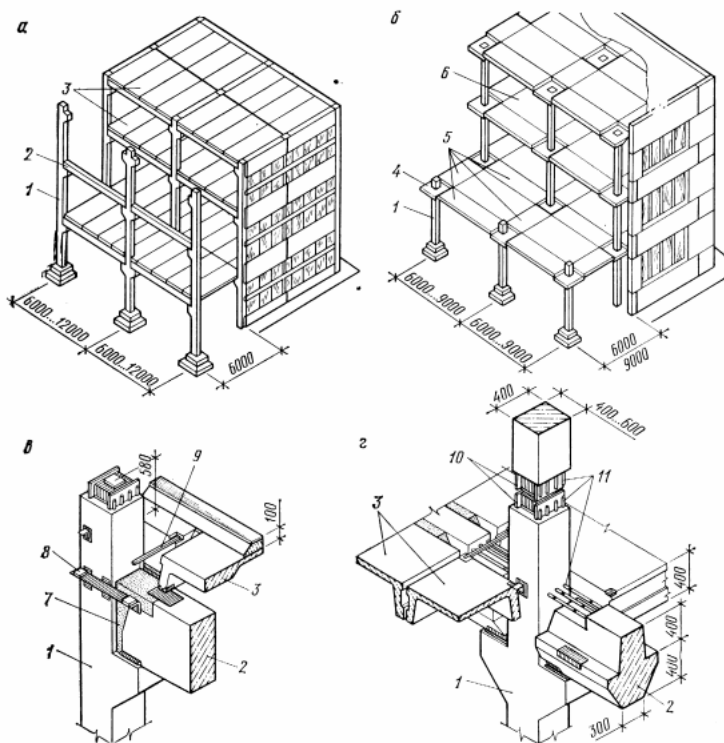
Конструкції перекриттів багатопверхових промислових будівель: а – балкове покриття; б – безбалкове покриття; в – опирання ригеля прямокутного перерізу; г – те саме, таврового перерізу; 1 – колона; 2 – ригель; 3 – панель перекриття; 4 – капітель; 5 – надколонні плити; 6 – прольотна плита; 7 – бетон; 8 – полиця для опирання плити перекриття; 9 – стикова накладка; 10 – сталевий оголовок; 11 – випуски арматури
